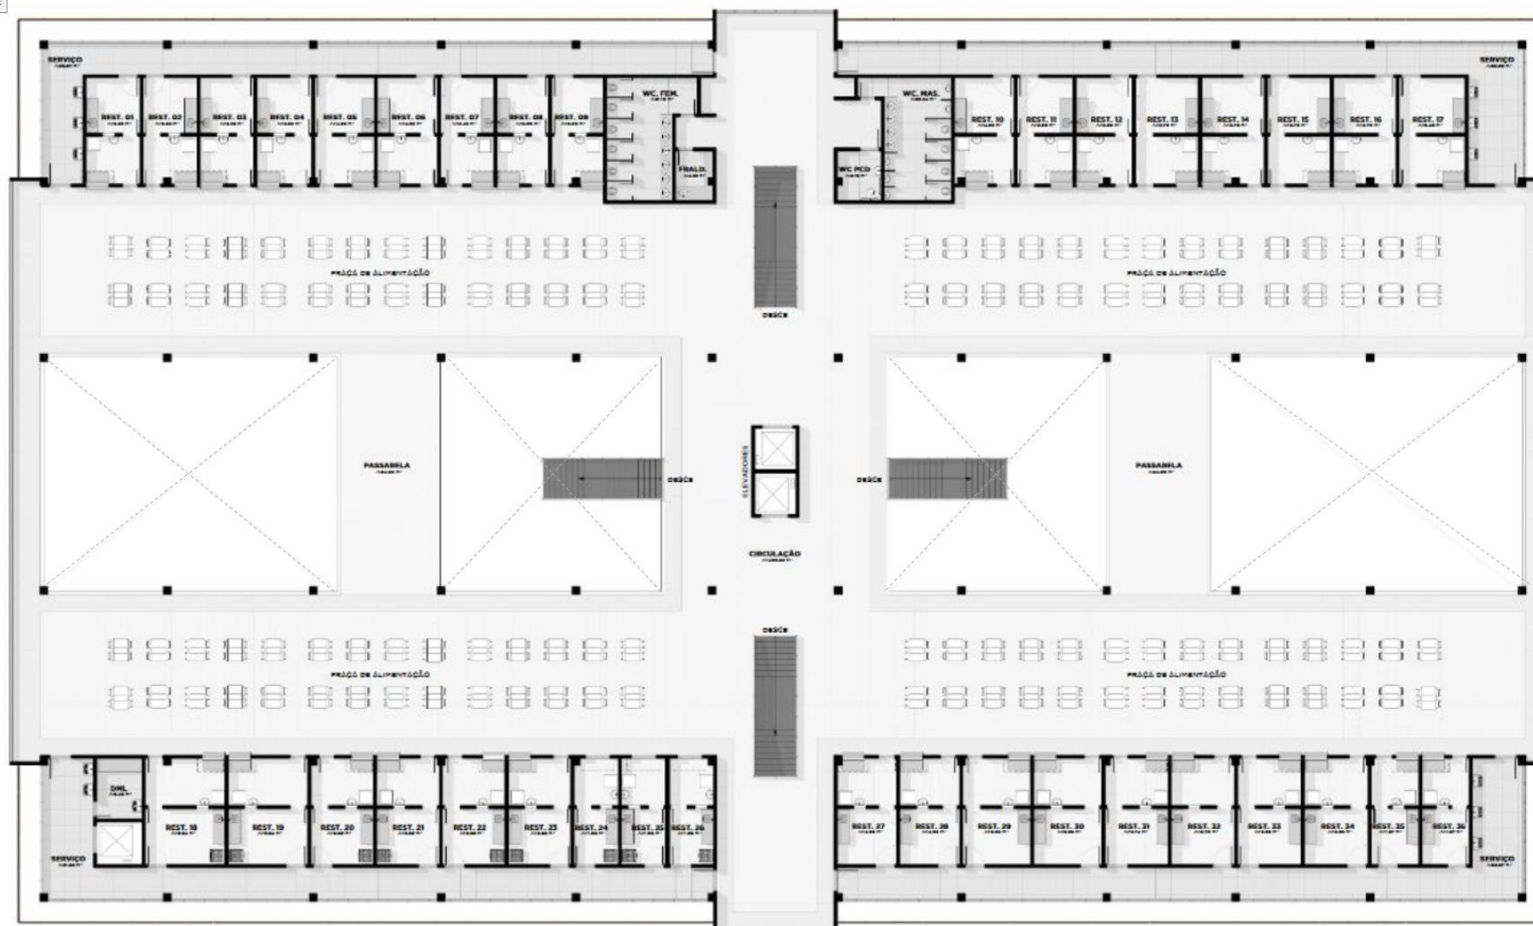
Projeto de Requalificação do Mercado Central: planta baixa segundo pavimento (praça de alimentação)
